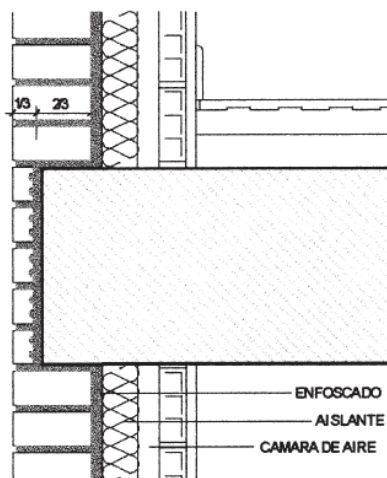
Solución constructiva de apoyo parcial sobre el forjado
